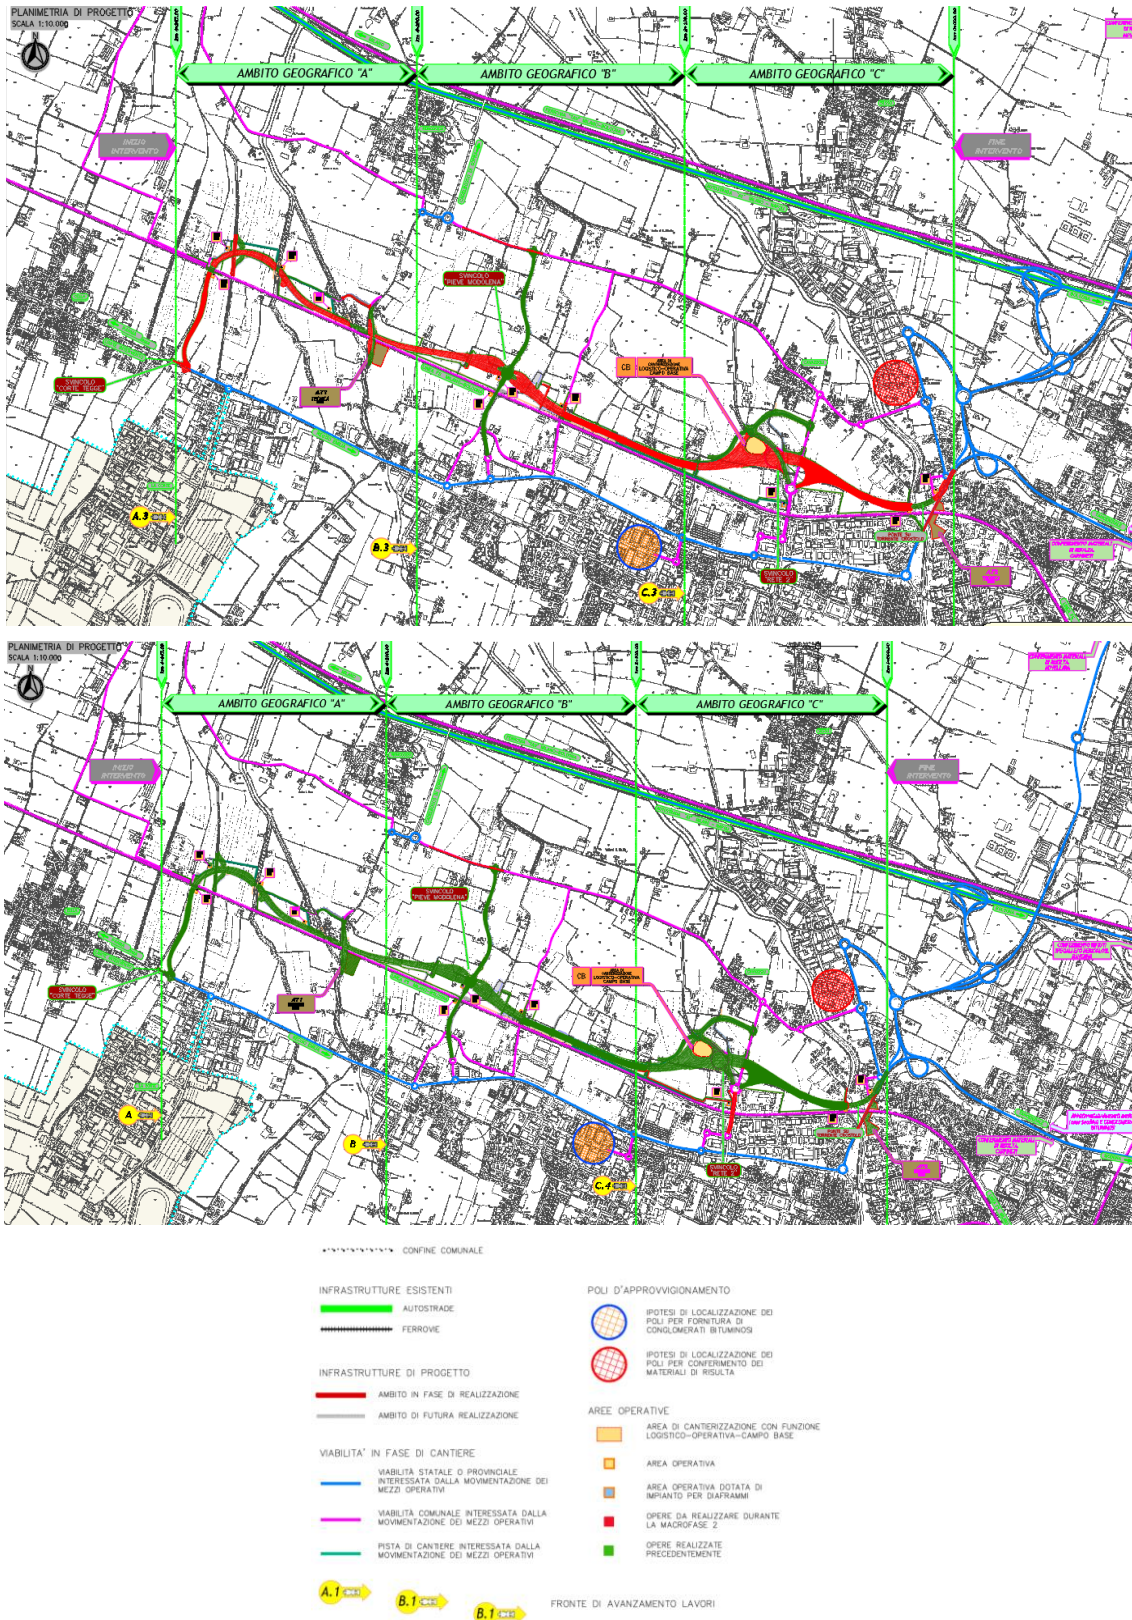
Planimetria sinottica dei percorsi di cantiere durante la Fase 3 e 4
